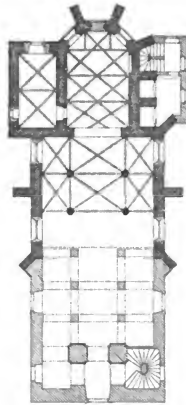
Suchenthal. Grundriss der Kirche.
